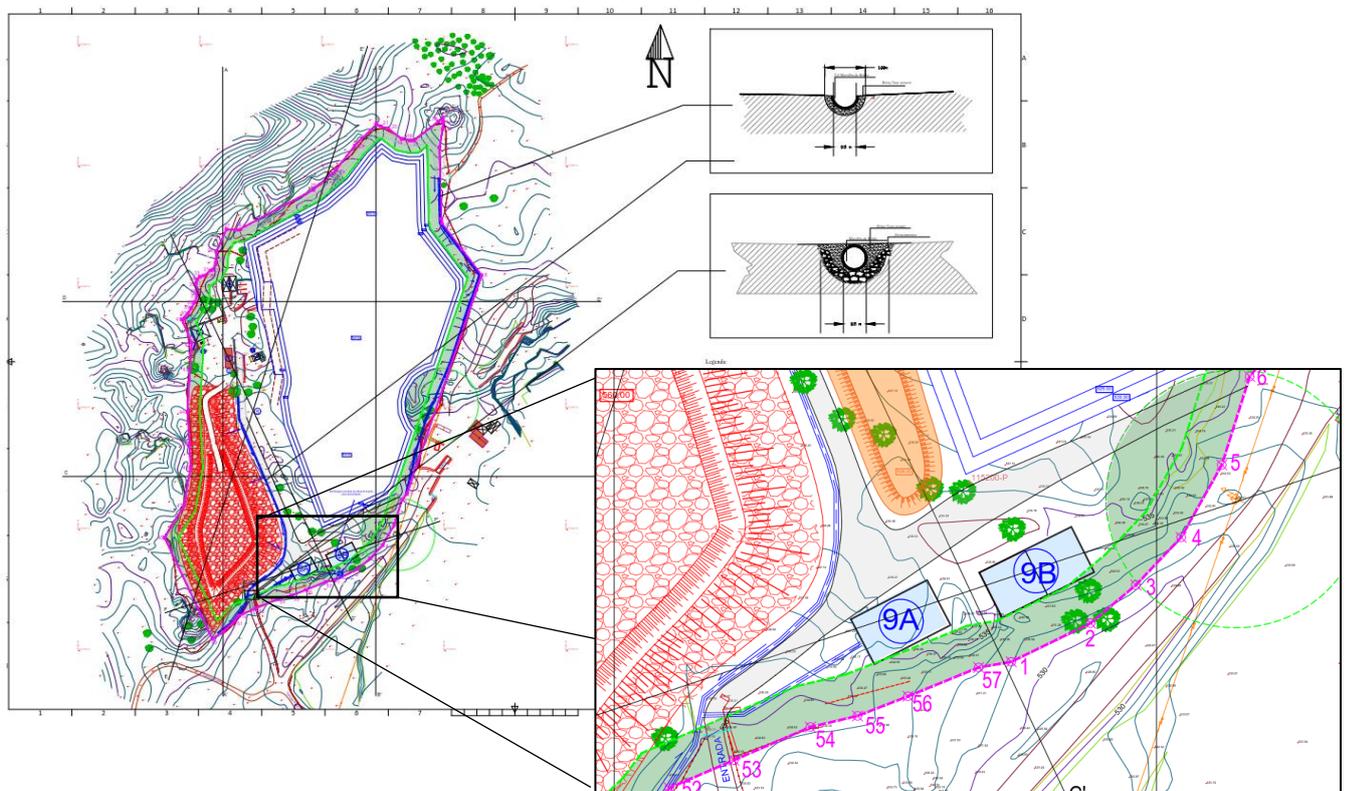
Plano de drenagem e pormenor dos tanques de decantação a instalar na área da pedra.
